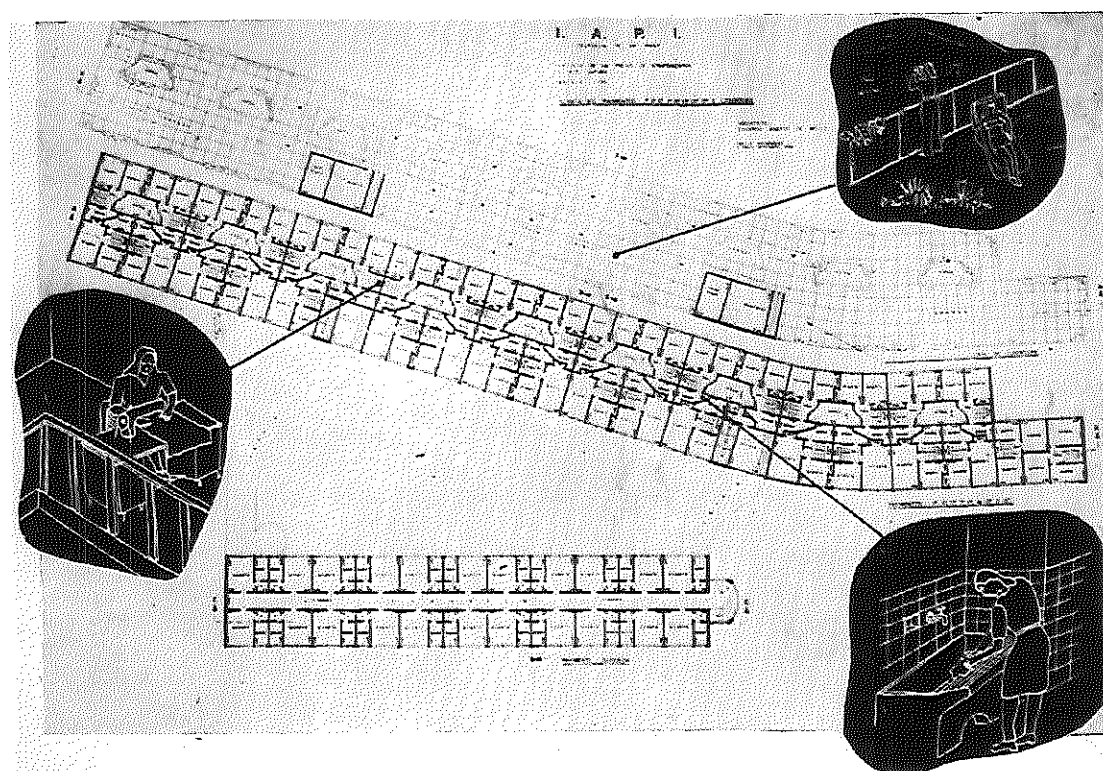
Planta do andar tipo 02 - Conjunto Japurá
